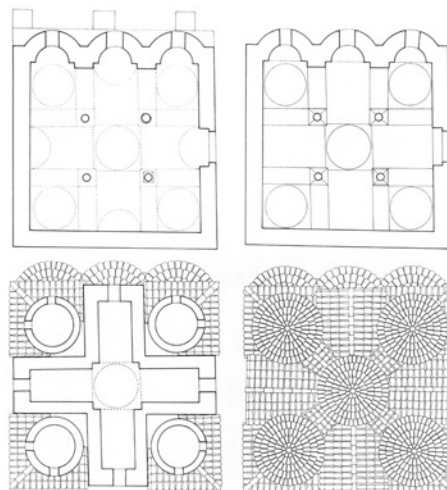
Cattolica di Stilo. Pianta "canonica", pianta dell'impalcato, pianta all'altezza delle volte a botte e pianta della copertura.
